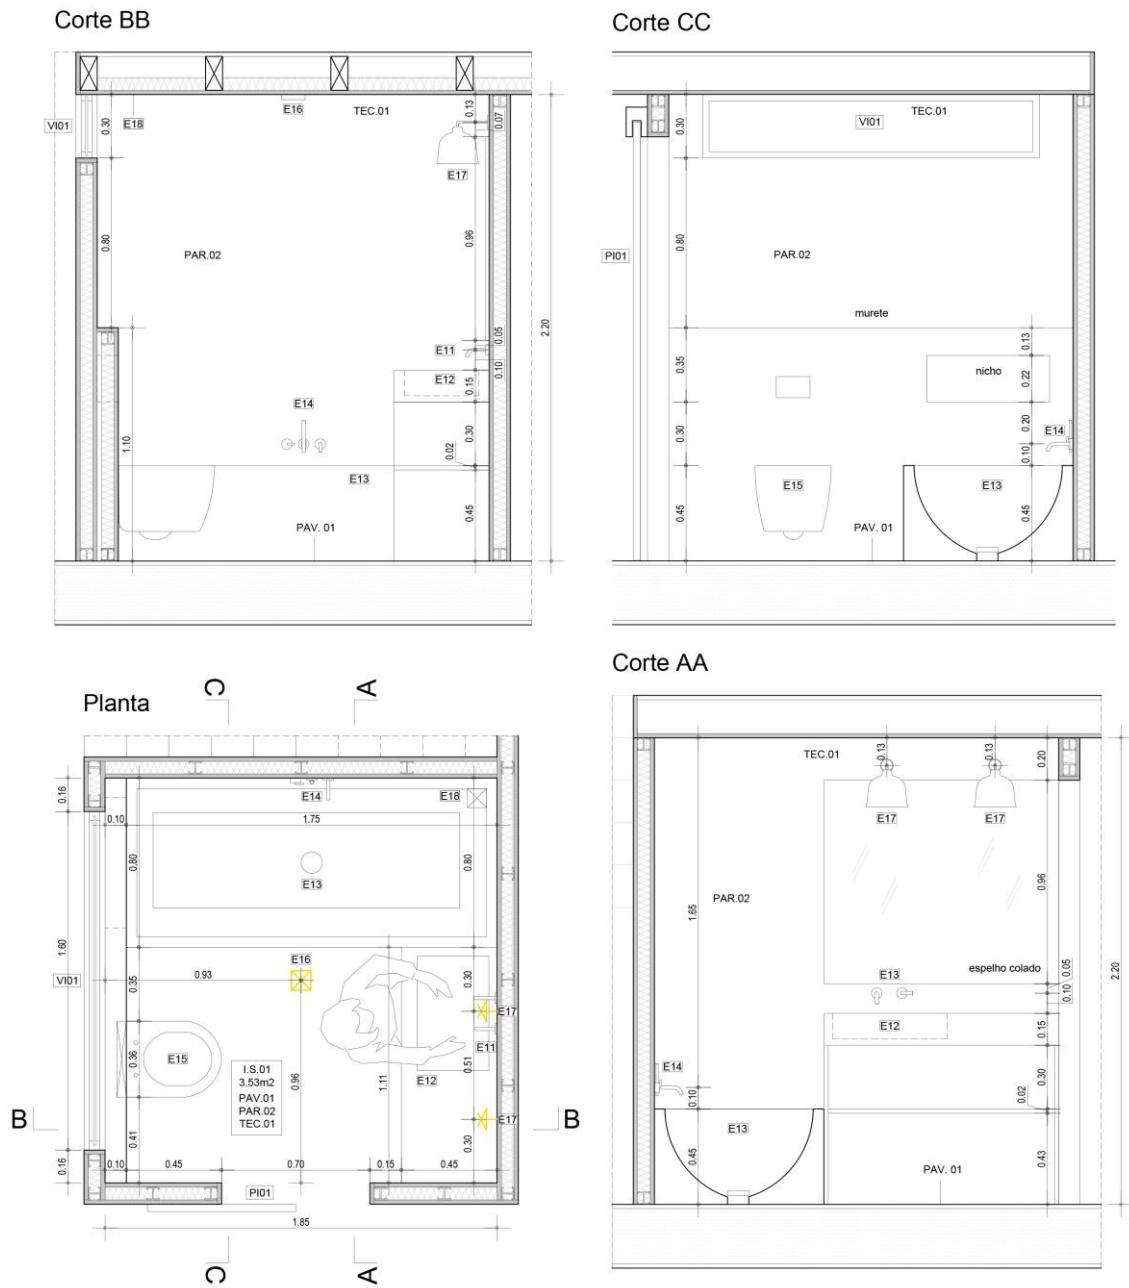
Desenhos de execução da instalação sanitária. Projecto 2.
